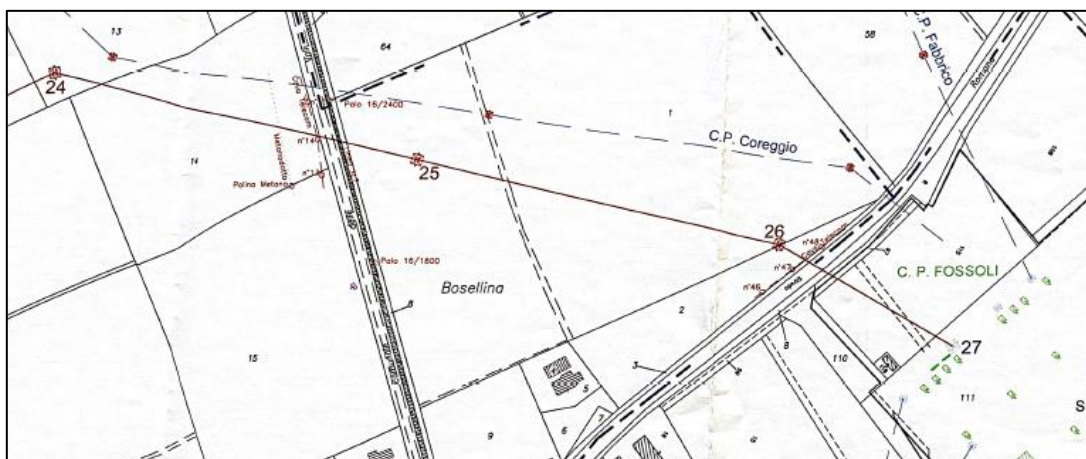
Planimetria con aree di scavo (ID 6108) da relazione di scavo (Archivio SABAP-BO)
